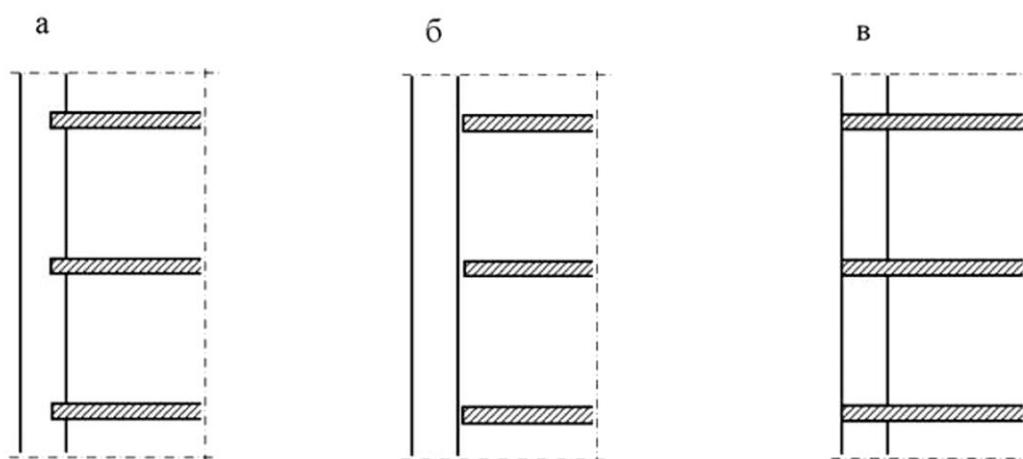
Типы наружных стен по восприятию вертикальной нагрузки
